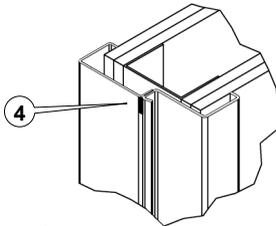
Zarge mit Gegenzarge verschweißt
